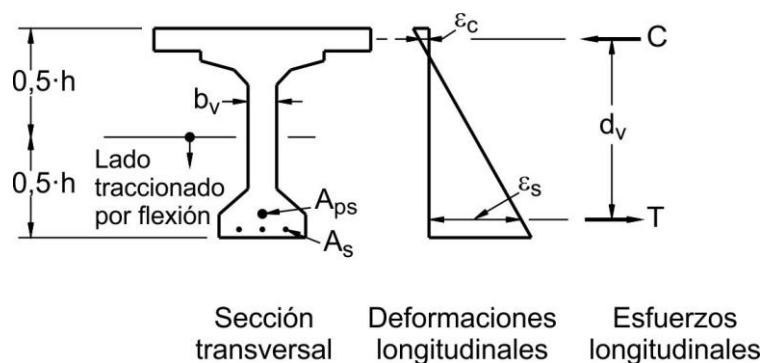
Deformación específica longitudinal, ϵ_s , para secciones que contienen menos que la mínima cantidad de armadura transversal
